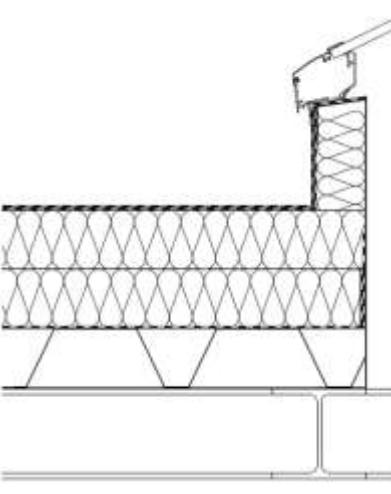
Beispiel für wärmegedämmtes, nicht belüftetes Dach mit Abdichtung auf Trapezblech, Anschluss an Attika
